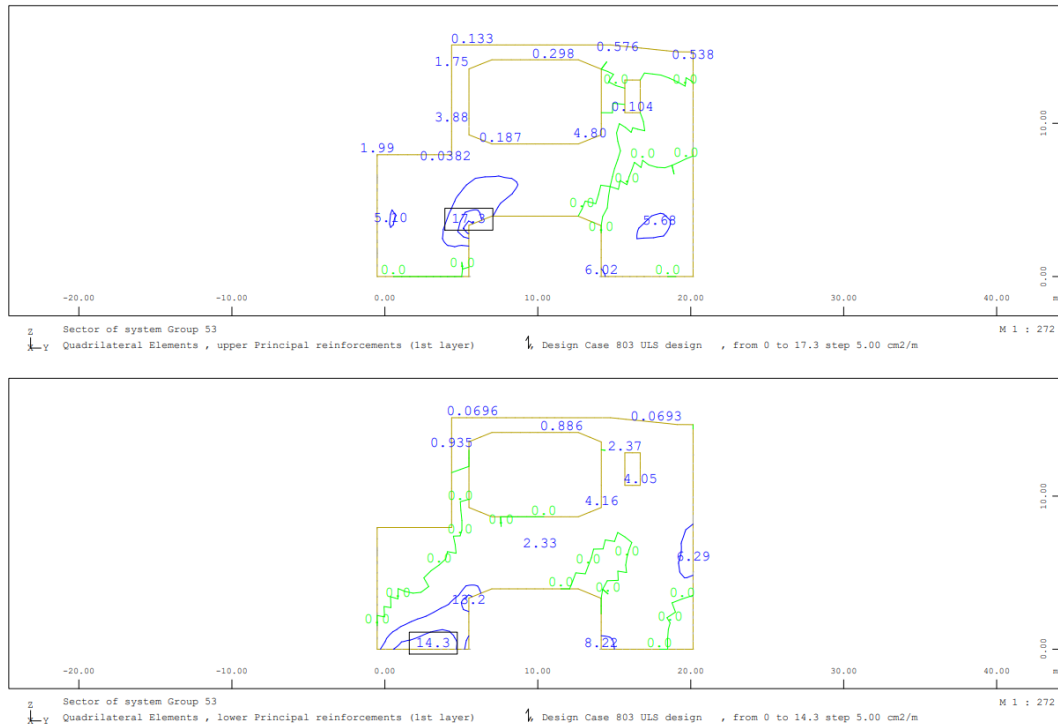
Armadura vertical na face exterior (sup.) e interior (inf.) – fachada Oeste da Estação - ELU
